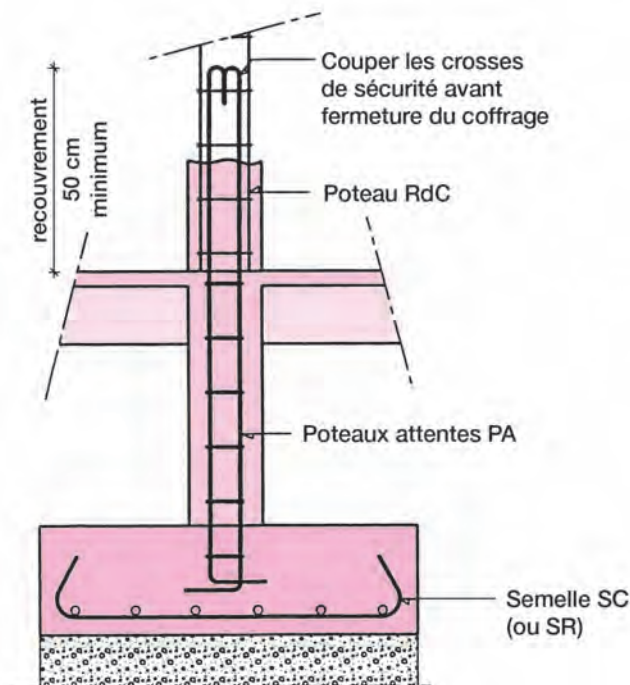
Détail de liaison d'un poteau sur semelle carrée (SC) ou rectangulaire (SR)
